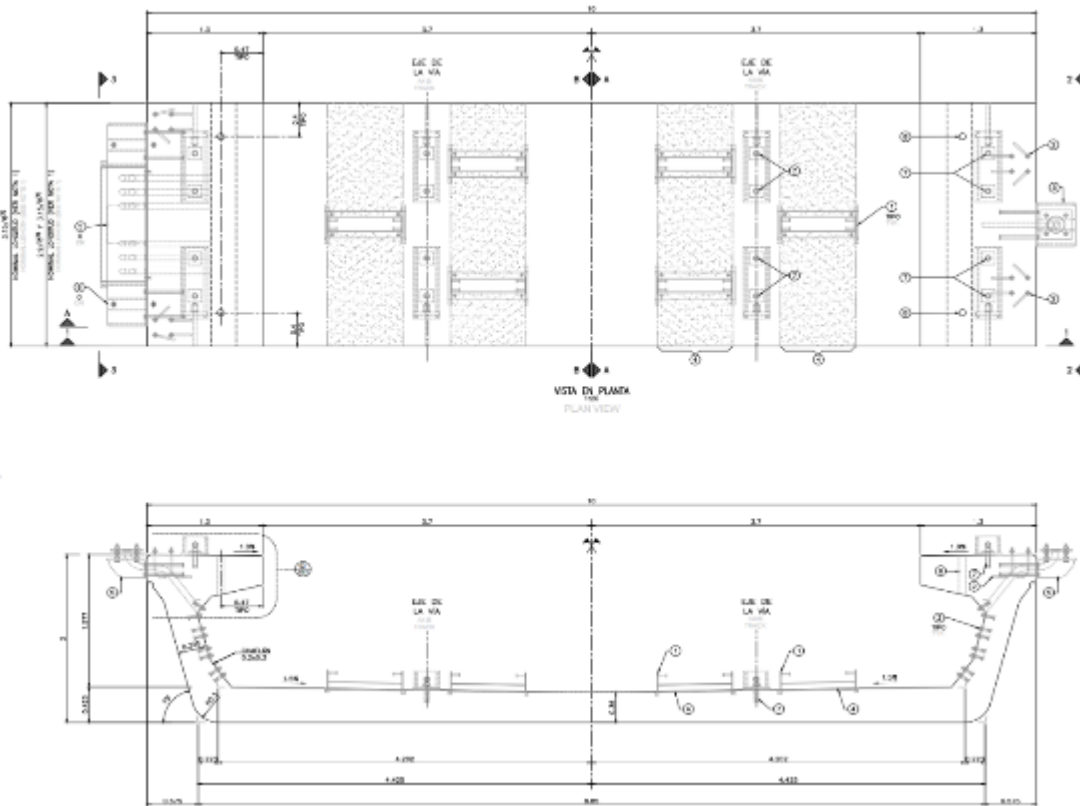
Dibujo estructural de sección de viga estándar (type W2 y type C) (UNIDAD:M)
